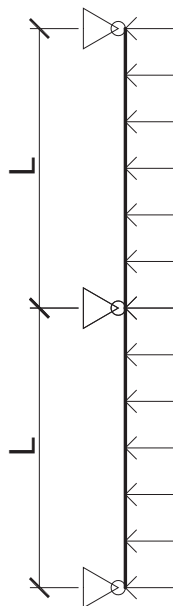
Схема нагружения - неразрезная двухпролетная балка
